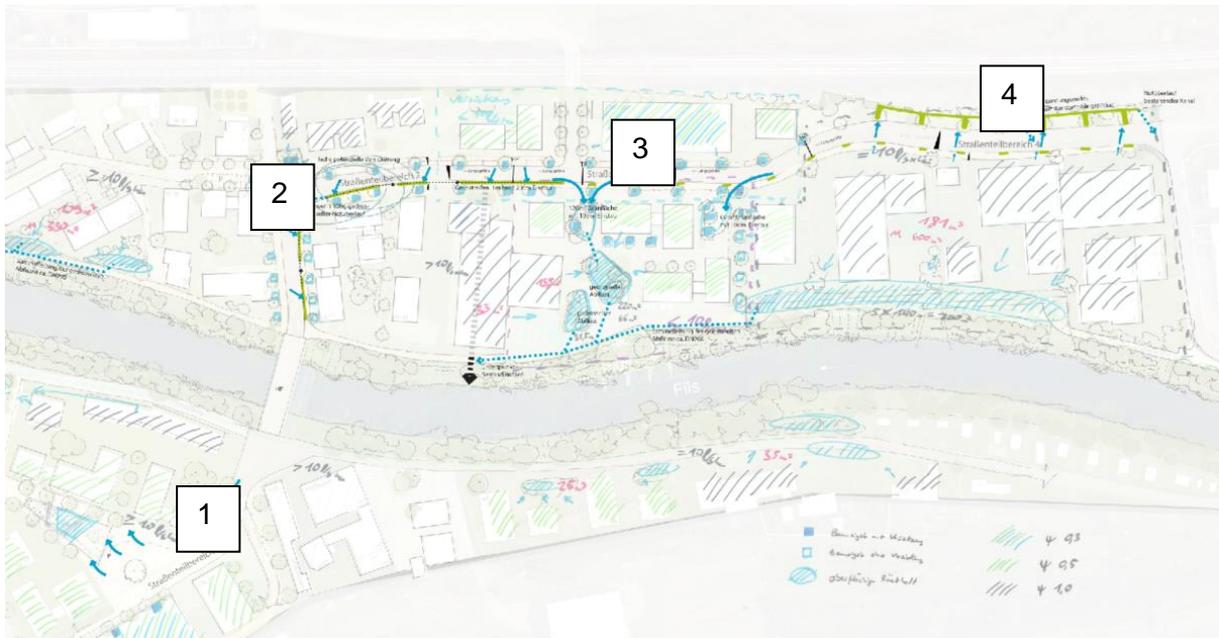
Lageplan Straßenabschnitte Planstatt Senner GmbH
